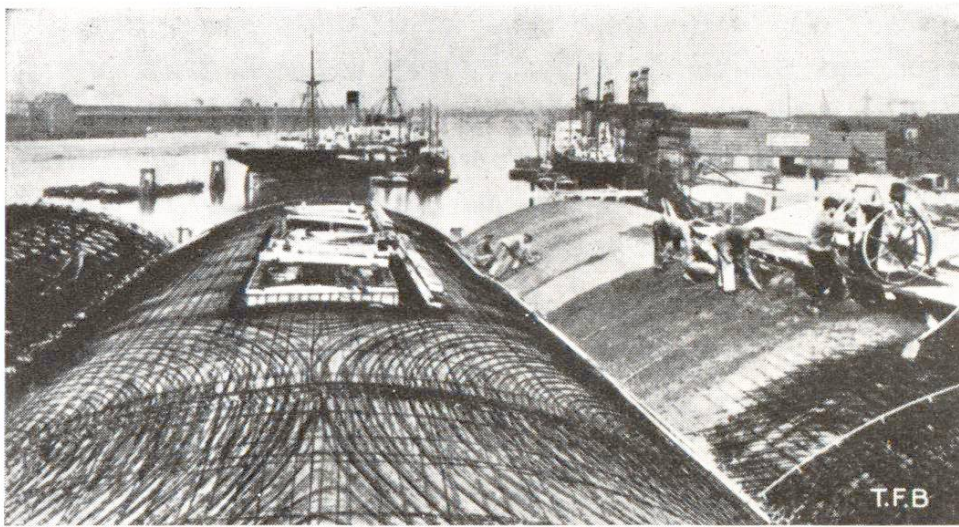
Voûtes minces surbaissées en construction. A gauche, armature, à droite, mise en œuvre du béton.
